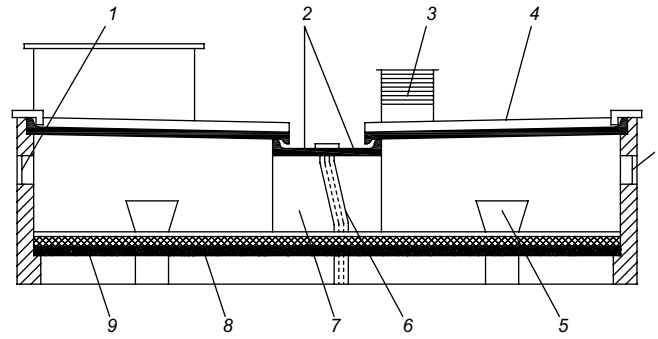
Кровля с открытым чердаком: 1 – вентилярующее отверстие в стене; 2 – железобетонный водосборный лоток; 3 – вытяжная шахта; 4 – железобетонная кровельная панель с безрулонной кровлей; 5 – оголовок вентиляционного блока; 6 – внутренний водосток; 7 – опорная панель; 8 – слой теплоизоляции с защитным слоем пароизоляции; 9 – панель перекрытия
